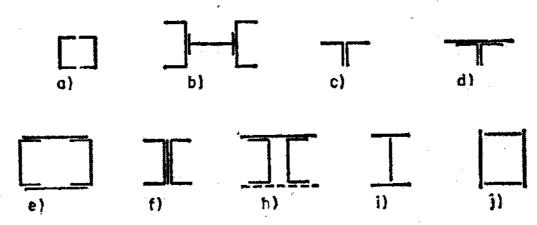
Ejemplos de piezas simples construidas por perfiles y/o chapas yuxtapuestas
